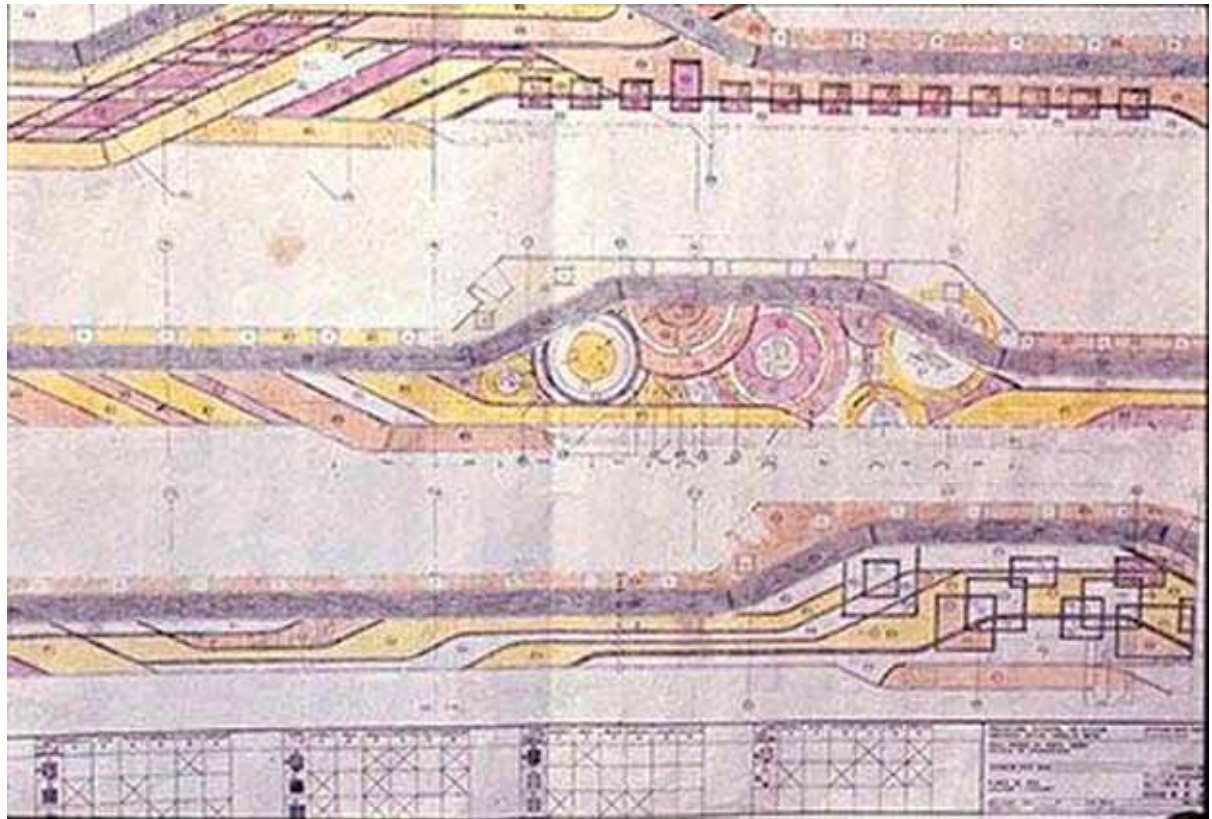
Planta de Piso da calçada do Projeto de Urbanização da Praia da Ponta Negra (1992). Fonte: Acervo Pessoal do Arquiteto Severiano Porto.
